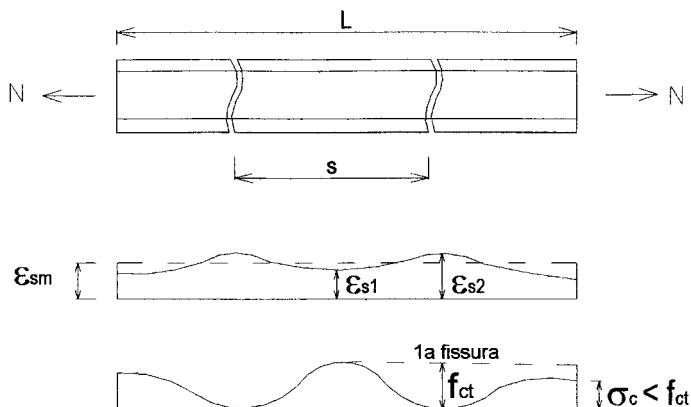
Mecanismo de fissuração em tirantes de concreto armado
